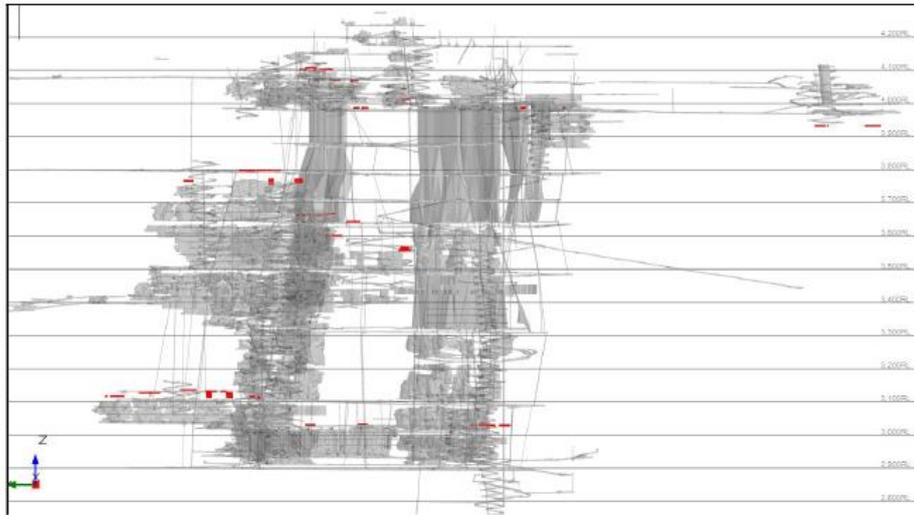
Caracterización Geomecánica para la estructura de Carmen Norte 3 (CN3)
